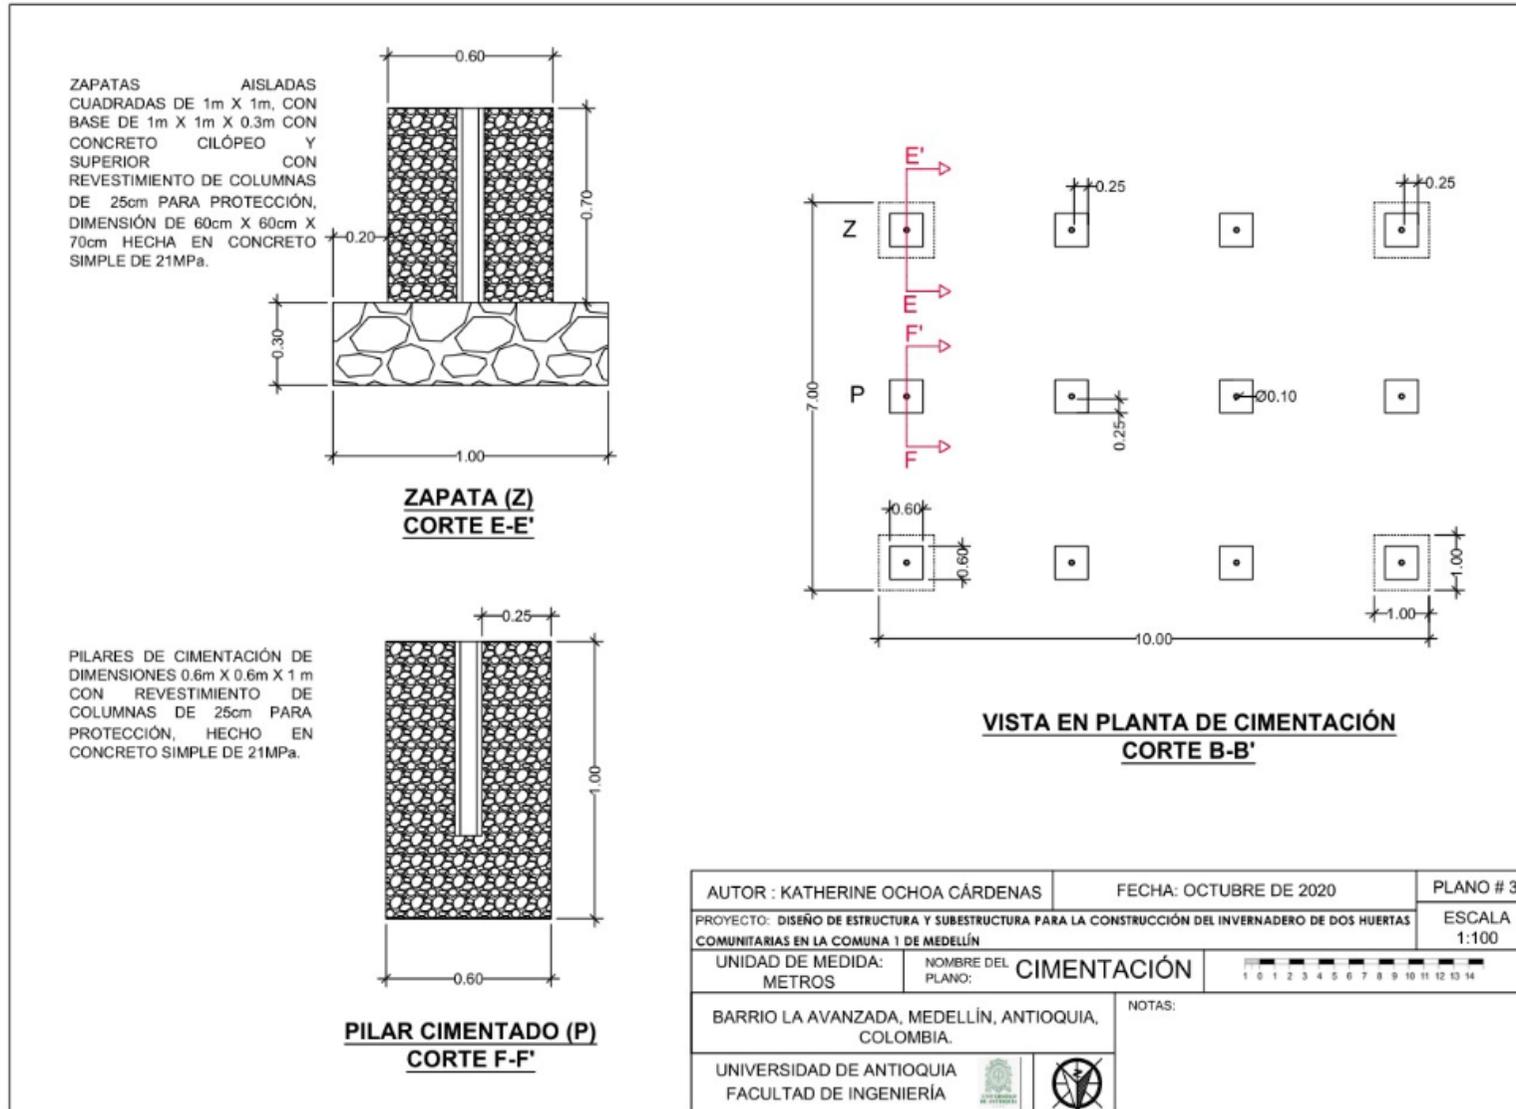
Plano #2 Cimentación, Barrio La Avanzada.
